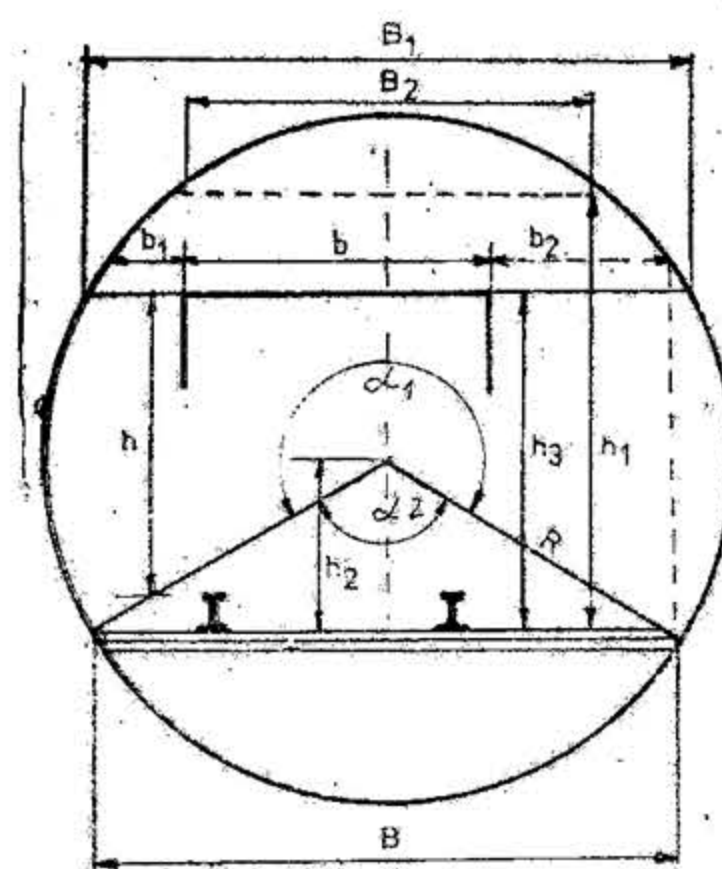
Elemente constructive ale profilului de galerie circular.
